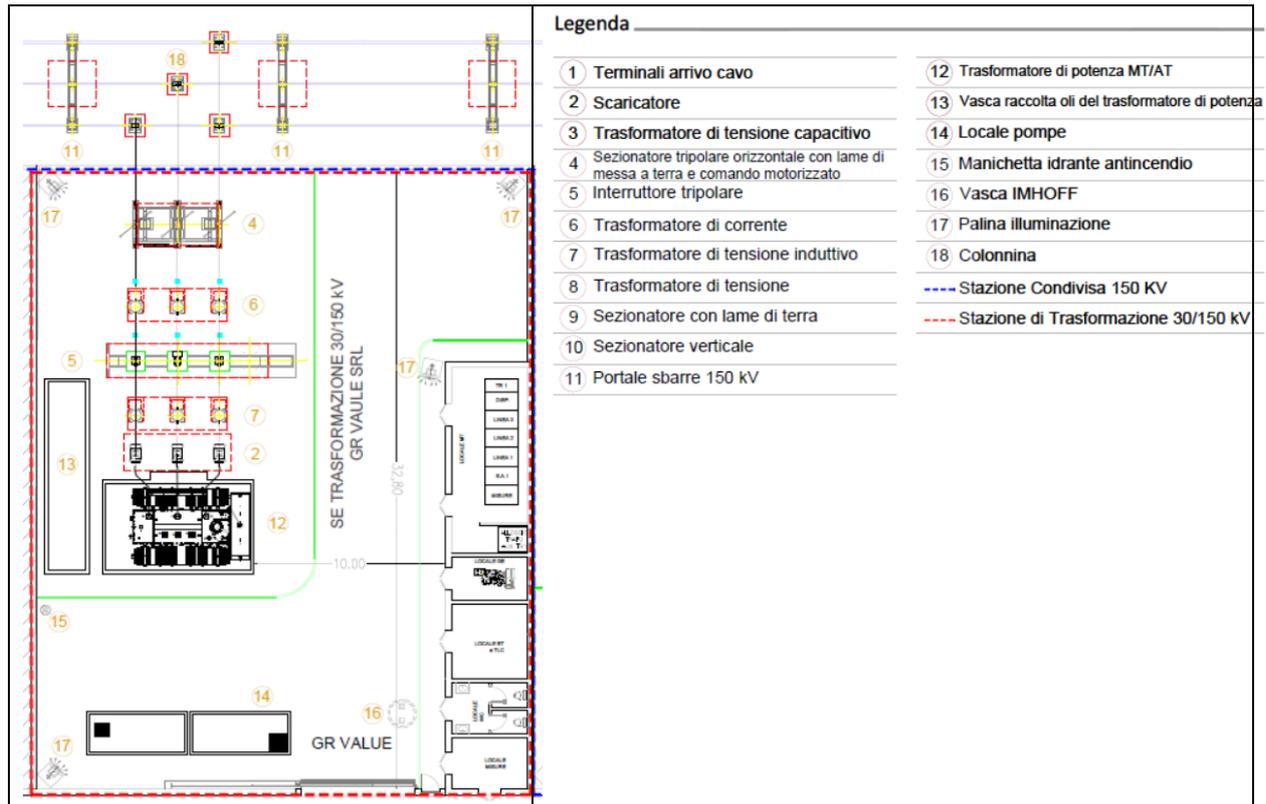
Stralcio Tavola pianta elettromeccanica della SE di trasformazione 30/150kV
